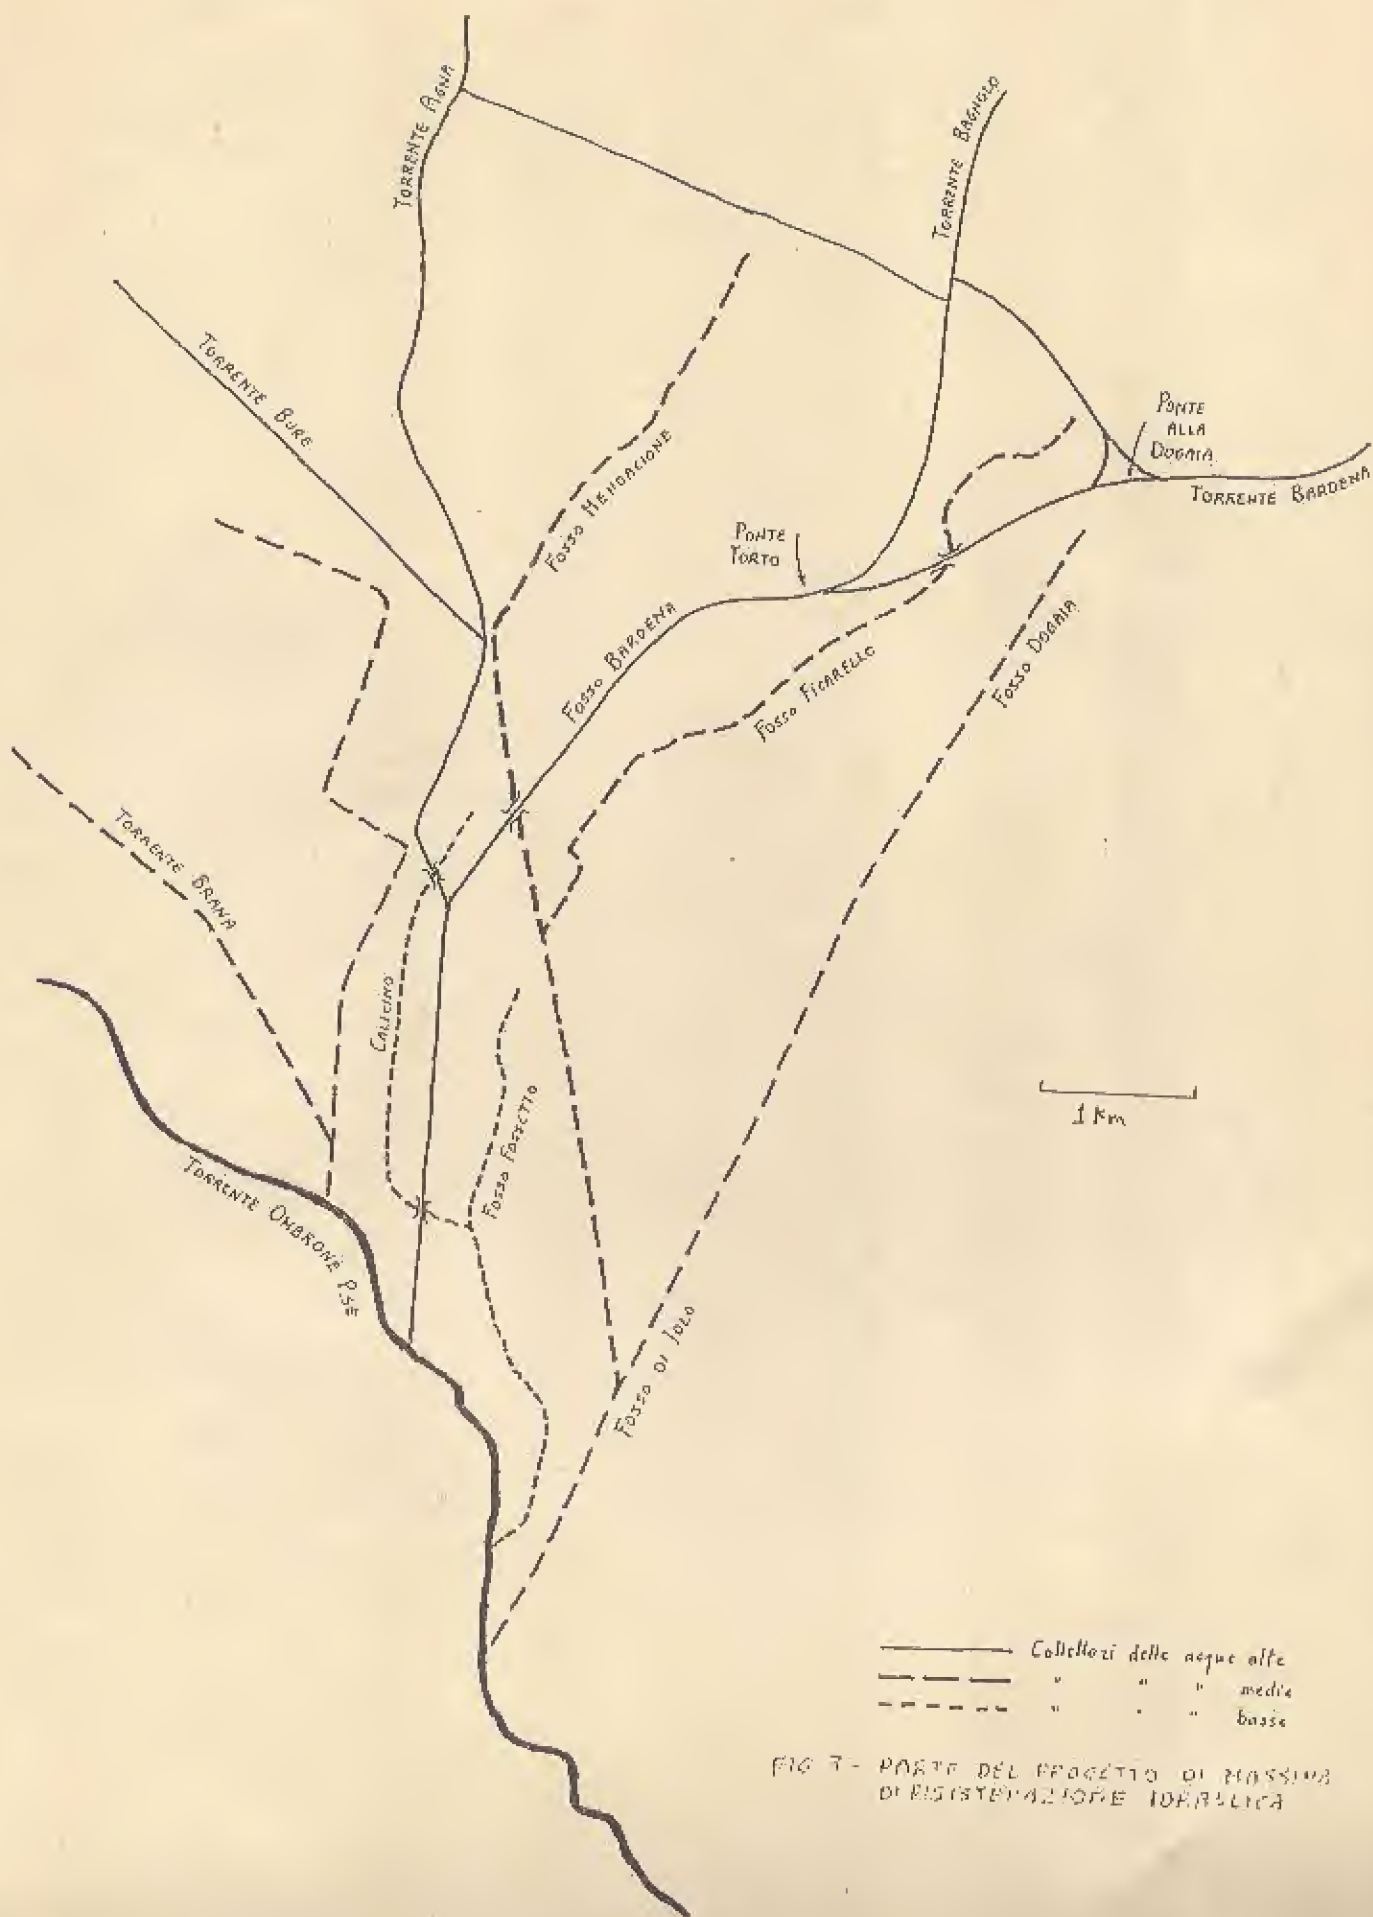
PIANO DEL PROGETTO DI MASSIMA
